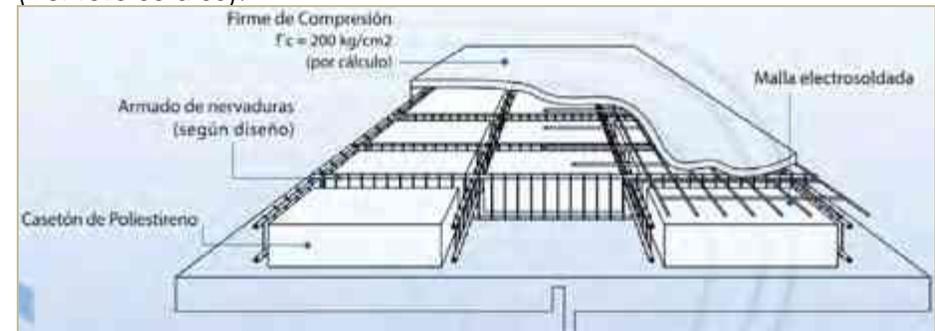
Esquema de sistema constructivo (losa reticular)
